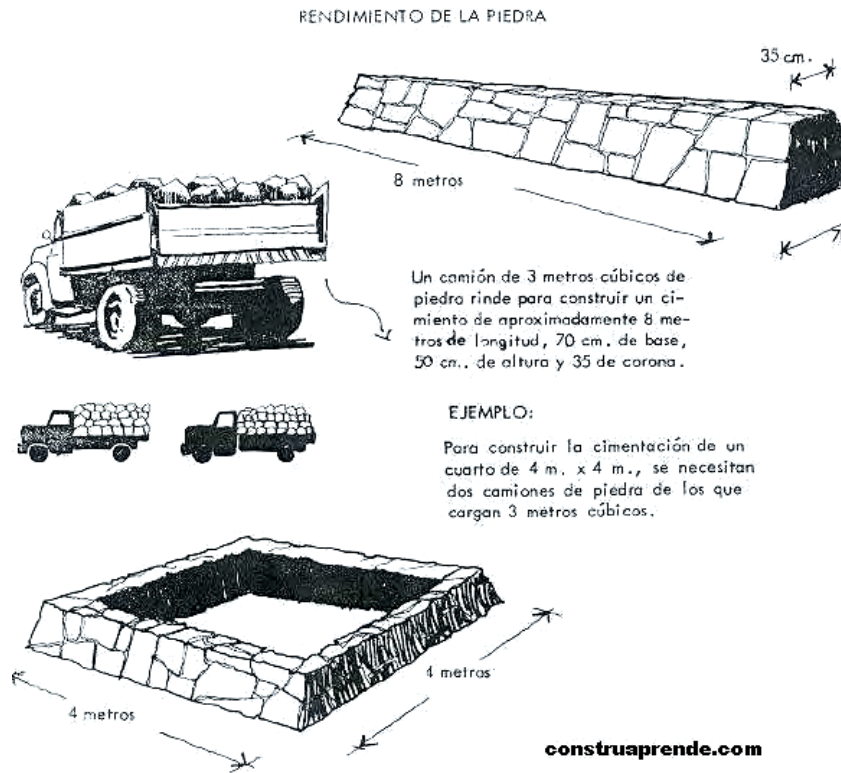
8 Rendimiento de la piedra para la construcción de muros.
